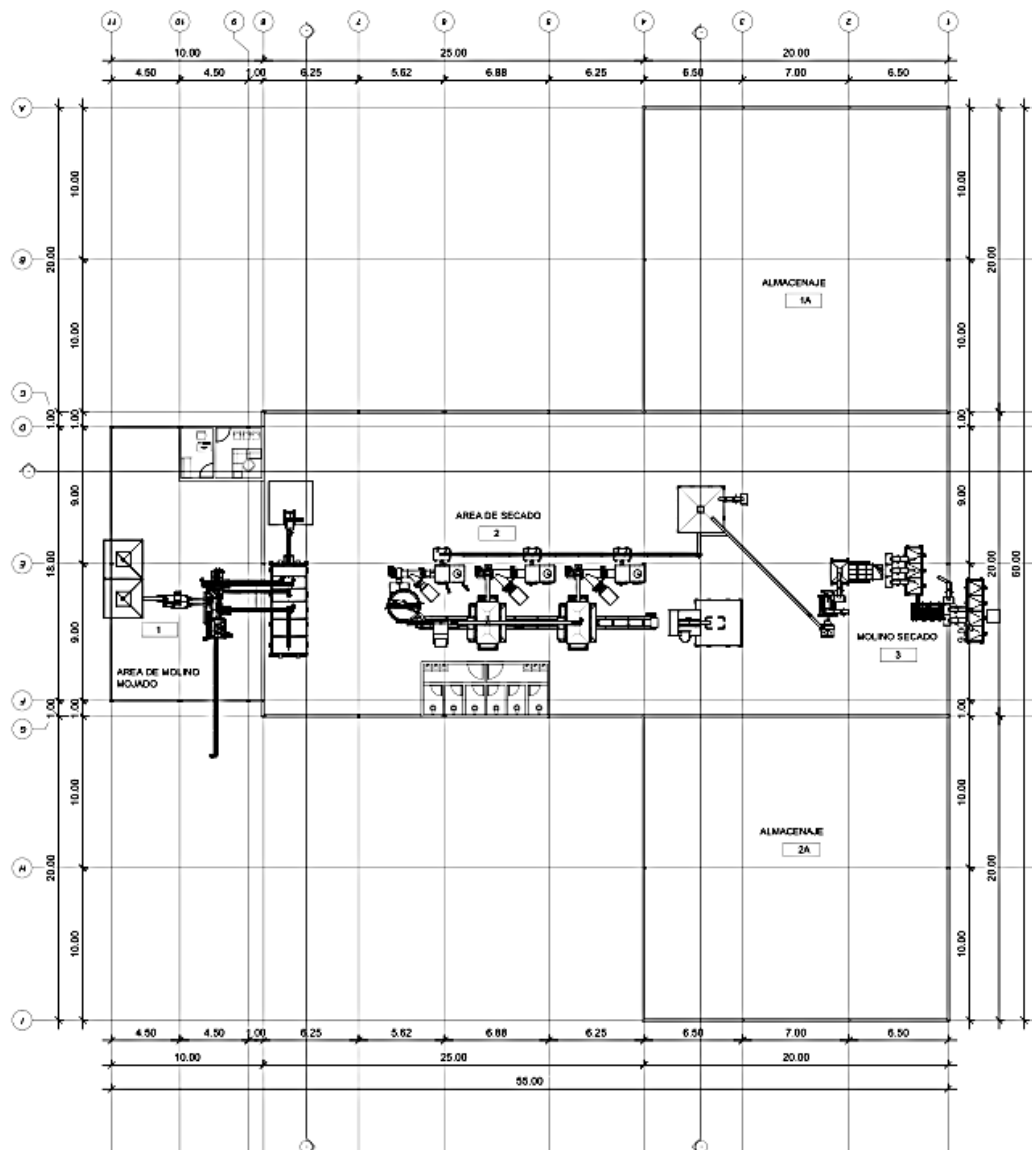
Planta Arquitectónica del Beneficio de Cafe
